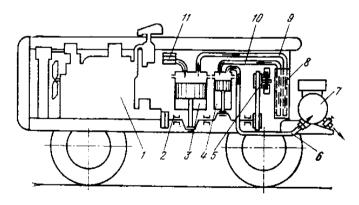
Схема поршневого двухступенчатого компрессора: 1 — двигатель внутреннего сгорания; 2 — коленчатый вал компрессора; 3 — цилиндр низкого давления; 4 — цилиндр высокого давления; 5 — вентилятор; 6 — трубопровод высокого давления; 7 — воздухосборник (ресивер); 8 — холодильник; 9, 10 — трубопроводы низкого давления; 11 — воздушный фильтр
